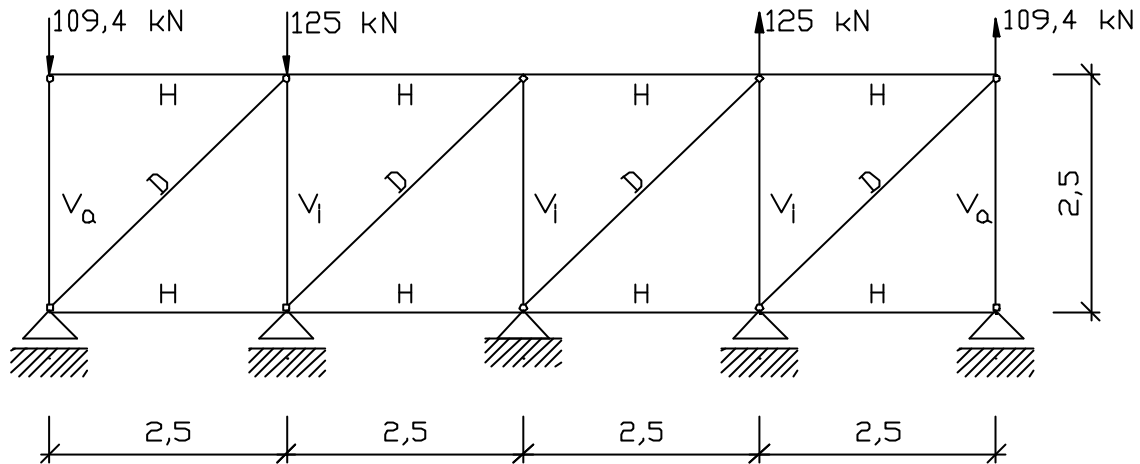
Ersatzmodell für Brettlagenholz mit diagonaler Struktur
